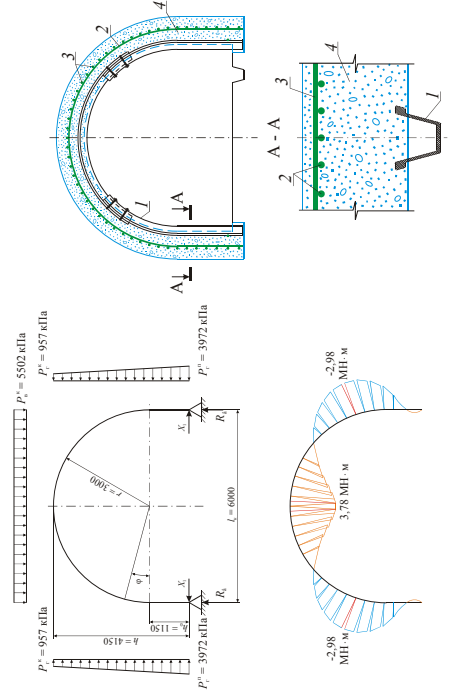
Изгибающий момент монолитной железобетонной крепи с вынесенным профилем СВП: 1 – металлическая рама из СВП; 2 – рабочая арматура; 3 – распределительная арматура; 4 – монолитный бетон
